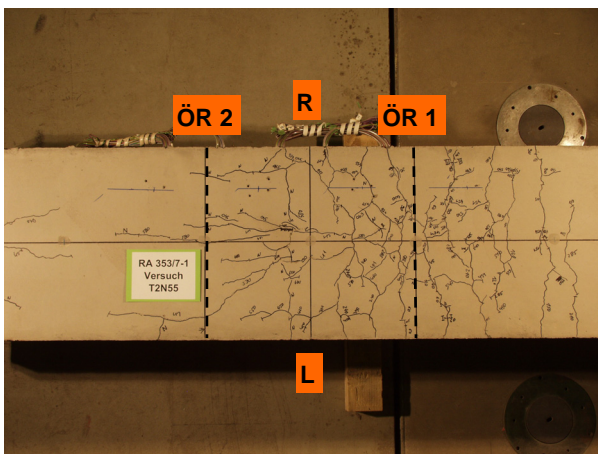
Rissbild auf der Betongurtoberseite
